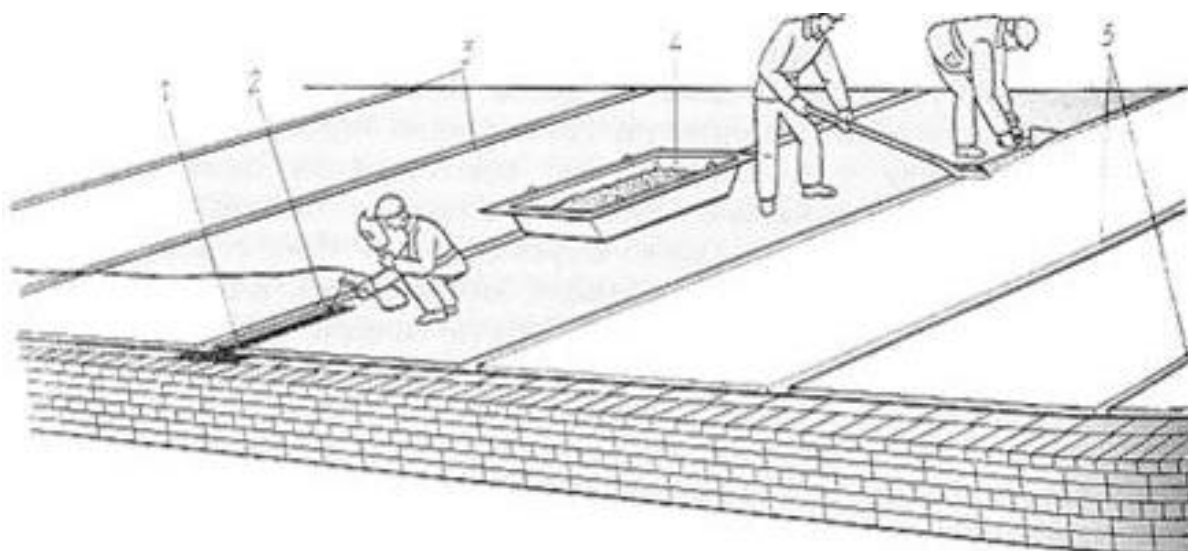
Установка анкеров и заделка стыков плит перекрытий: 1 - "Т-образный" анкер, заложенный в кладку, 2 - сварка стальных связей, 3 - швы, заделанные раствором М-100, 4 - ящик с раствором, 5 - швы, не заделанные раствором.
